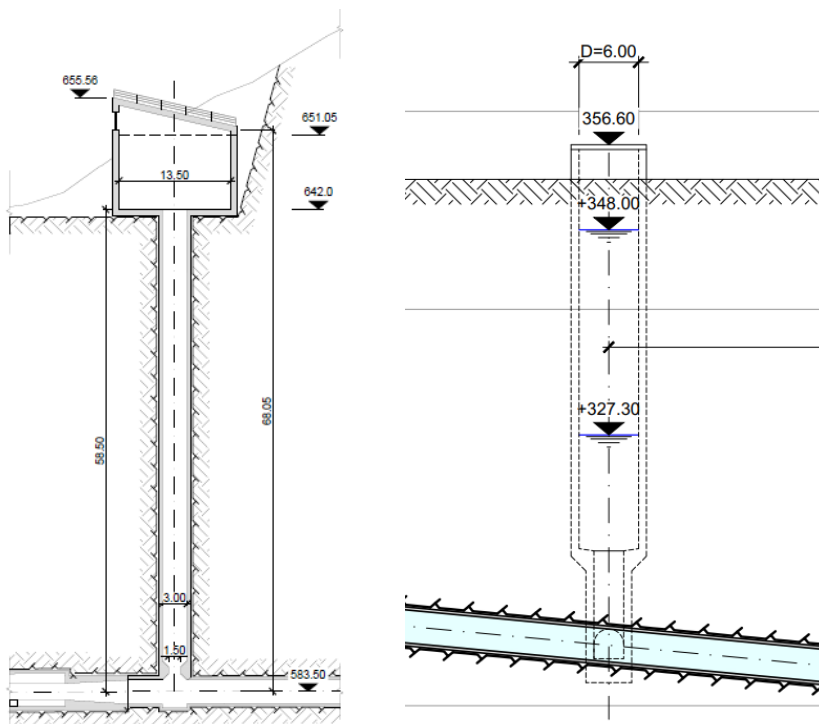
Pozzo piezometrico di monte (sinistra) e di valle (destra): stato di progetto.
